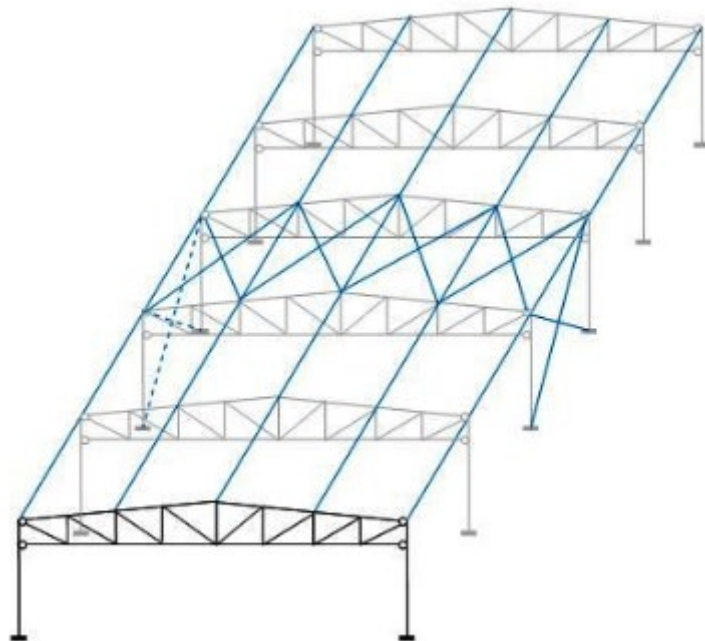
Pórtico estructural para un edificio típico de una sola planta
